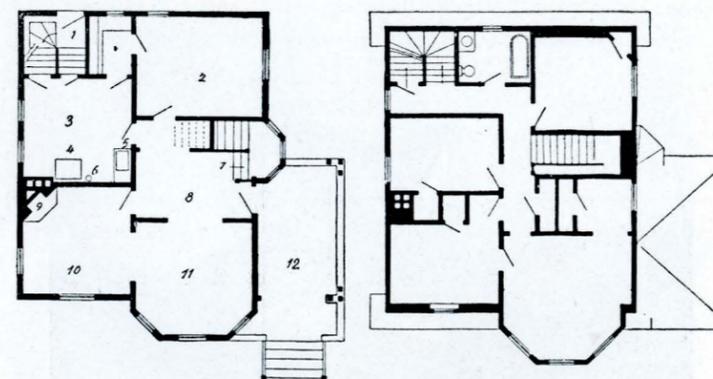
Pianta del piano terreno e del primo piano di una casetta costruita dalla « Niagara Development Company ».
